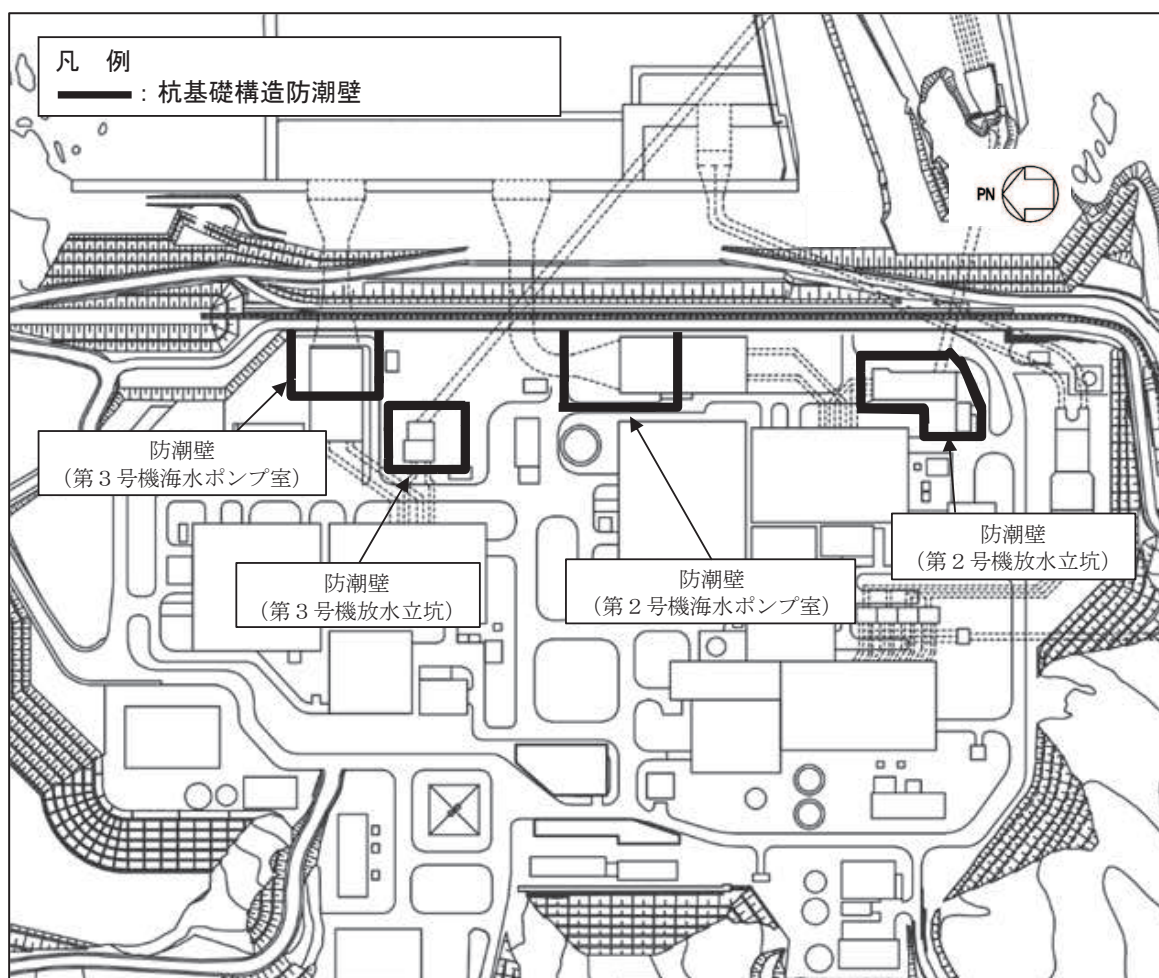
防潮壁（杭基礎）の平面配置図
